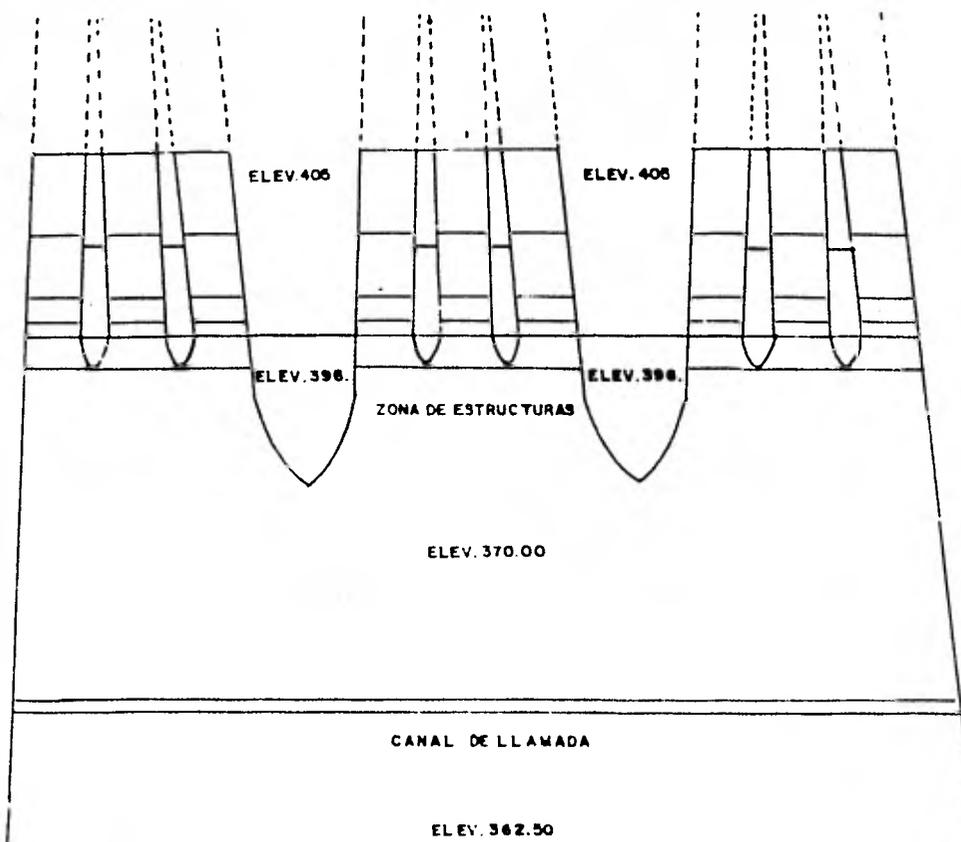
ESQUEMA DE LAS EXCAVACION DE LA ZONA DE ESTRUCTURAS Y EL CANAL DE LLAMADA
